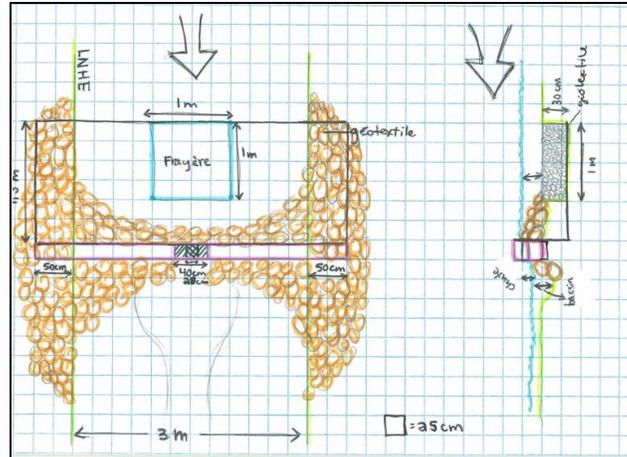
Plan détaillé du seuil P-032 du ruisseau des Pères
